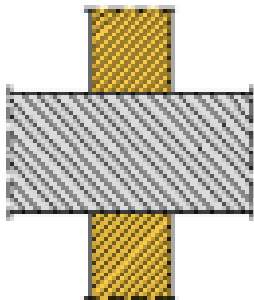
Detalle unión rígida (herramienta oficial de cálculo del CTE)
